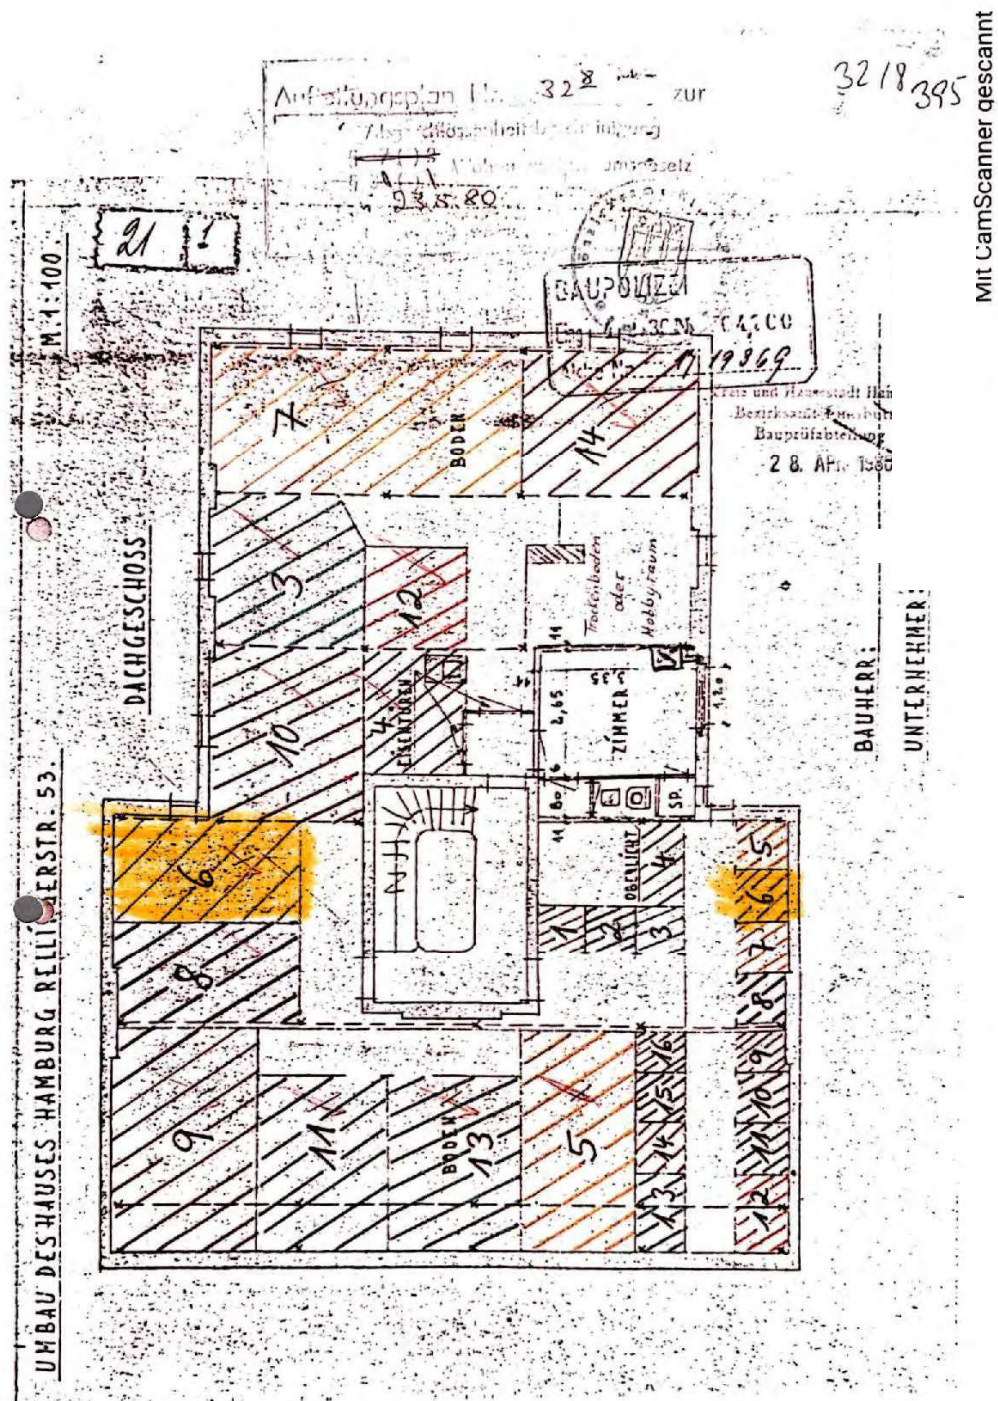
Grundriss DG mit Kennzeichnung zugehöriger Dachbodenbereiche
